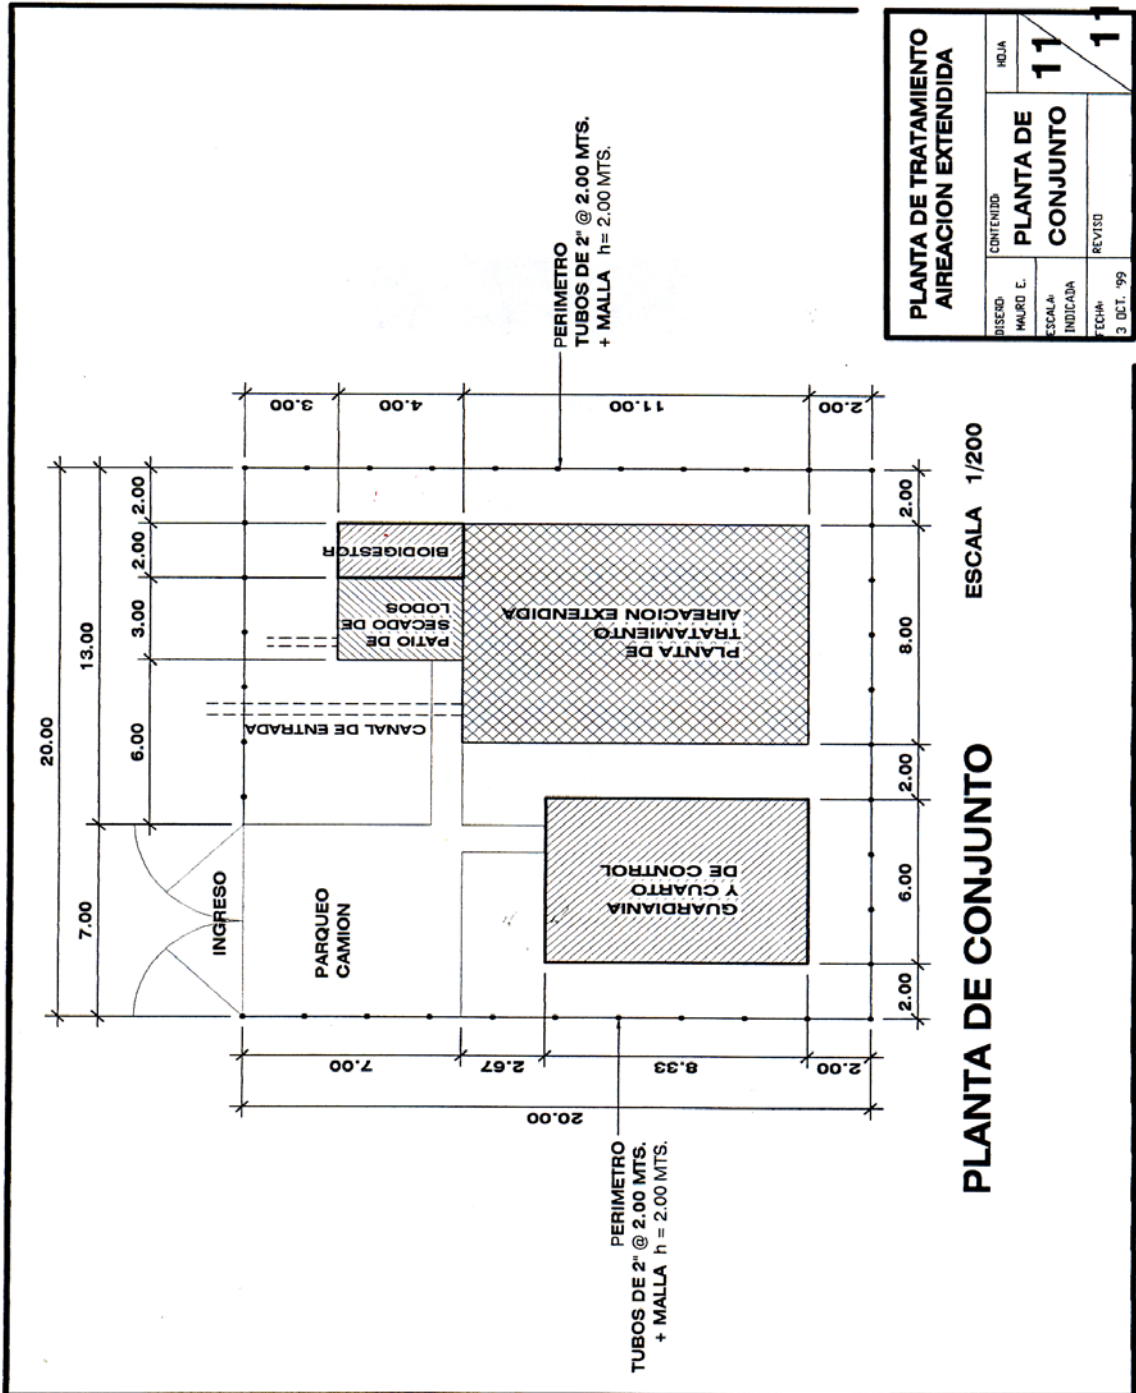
Plano de la planta de conjunto de la planta de tratamiento de aireación extendida.
